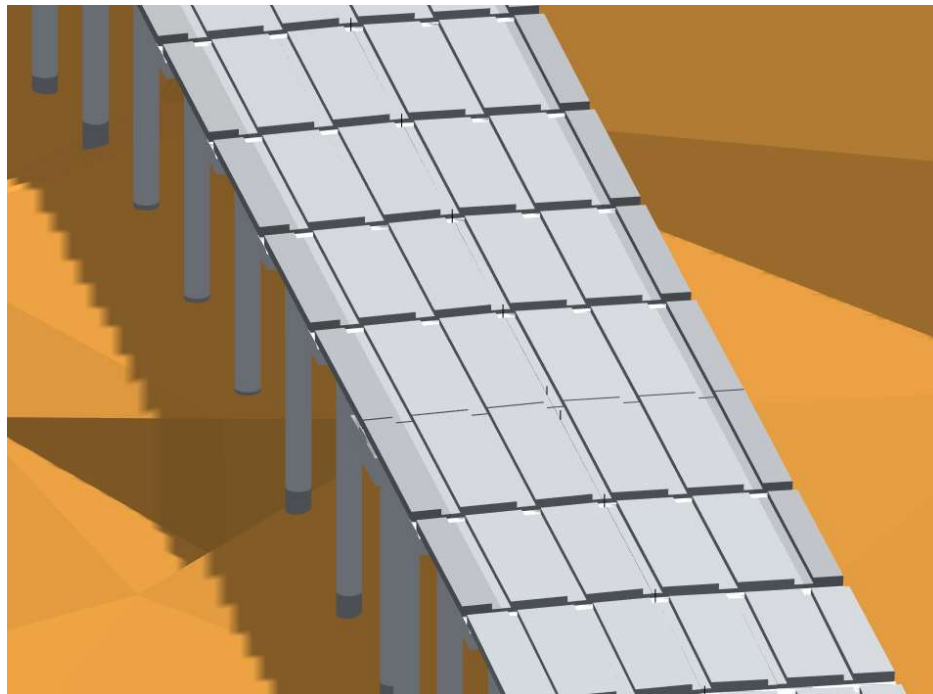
Isometri Model *Redesign Half Slab* Tipe – 2C
